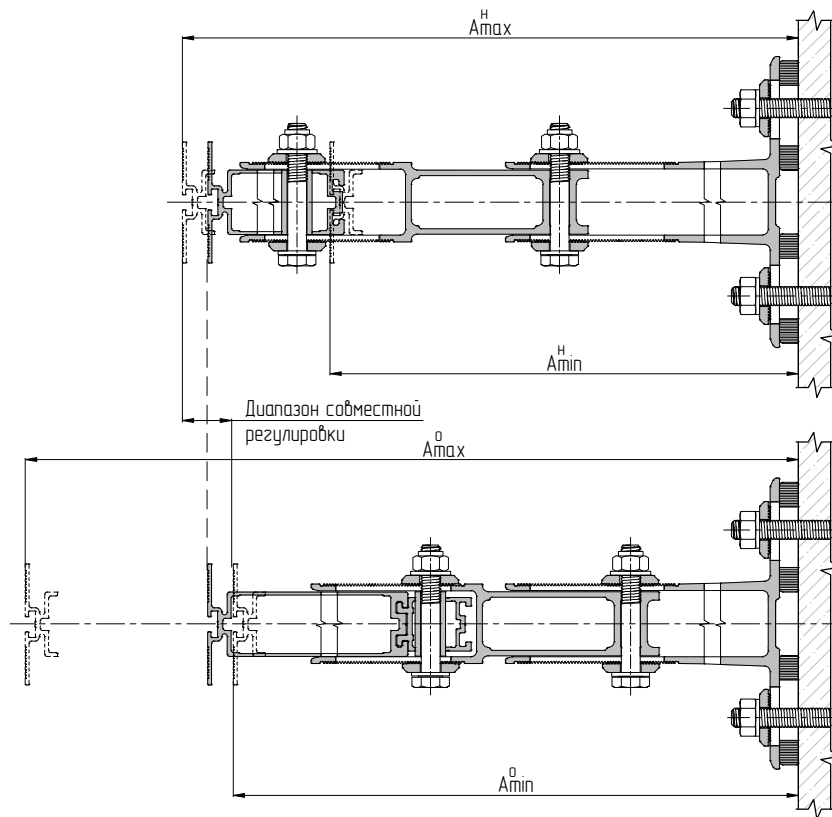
Рисунок VI – для схем сопряжения 6 и 14, схем 8 и 14, схем 8 и 16, схем 14 и 22, схем 16 и 22, схем 16 и 24.
